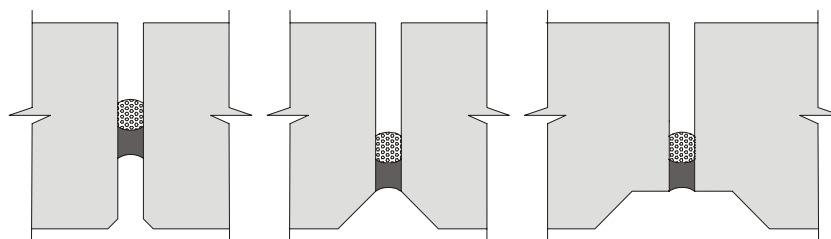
Secções transversais de tipos de juntas reentrantes (BARTH, 1997)
